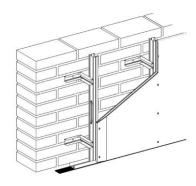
Detalle trasdosado con sistema cartón-yeso. (Web Pladur)
